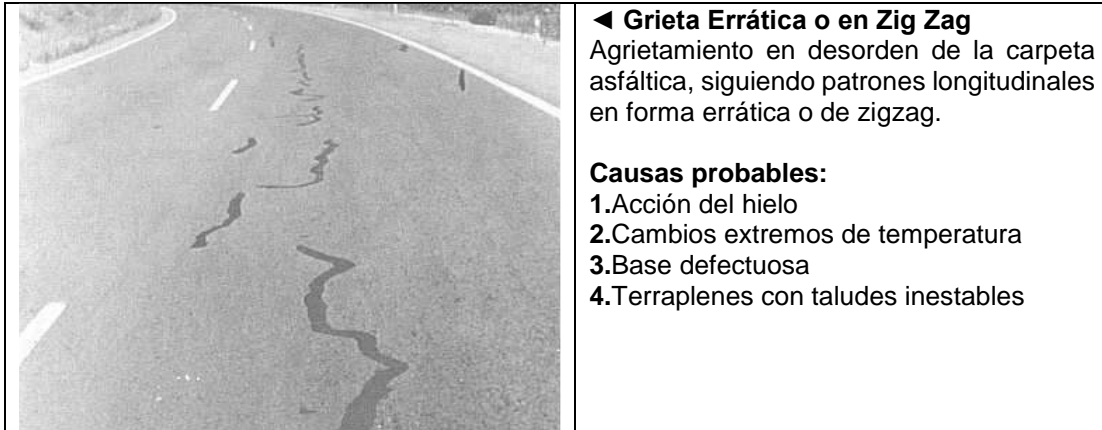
Grieta en Zig - Zag, definición y causas probables
